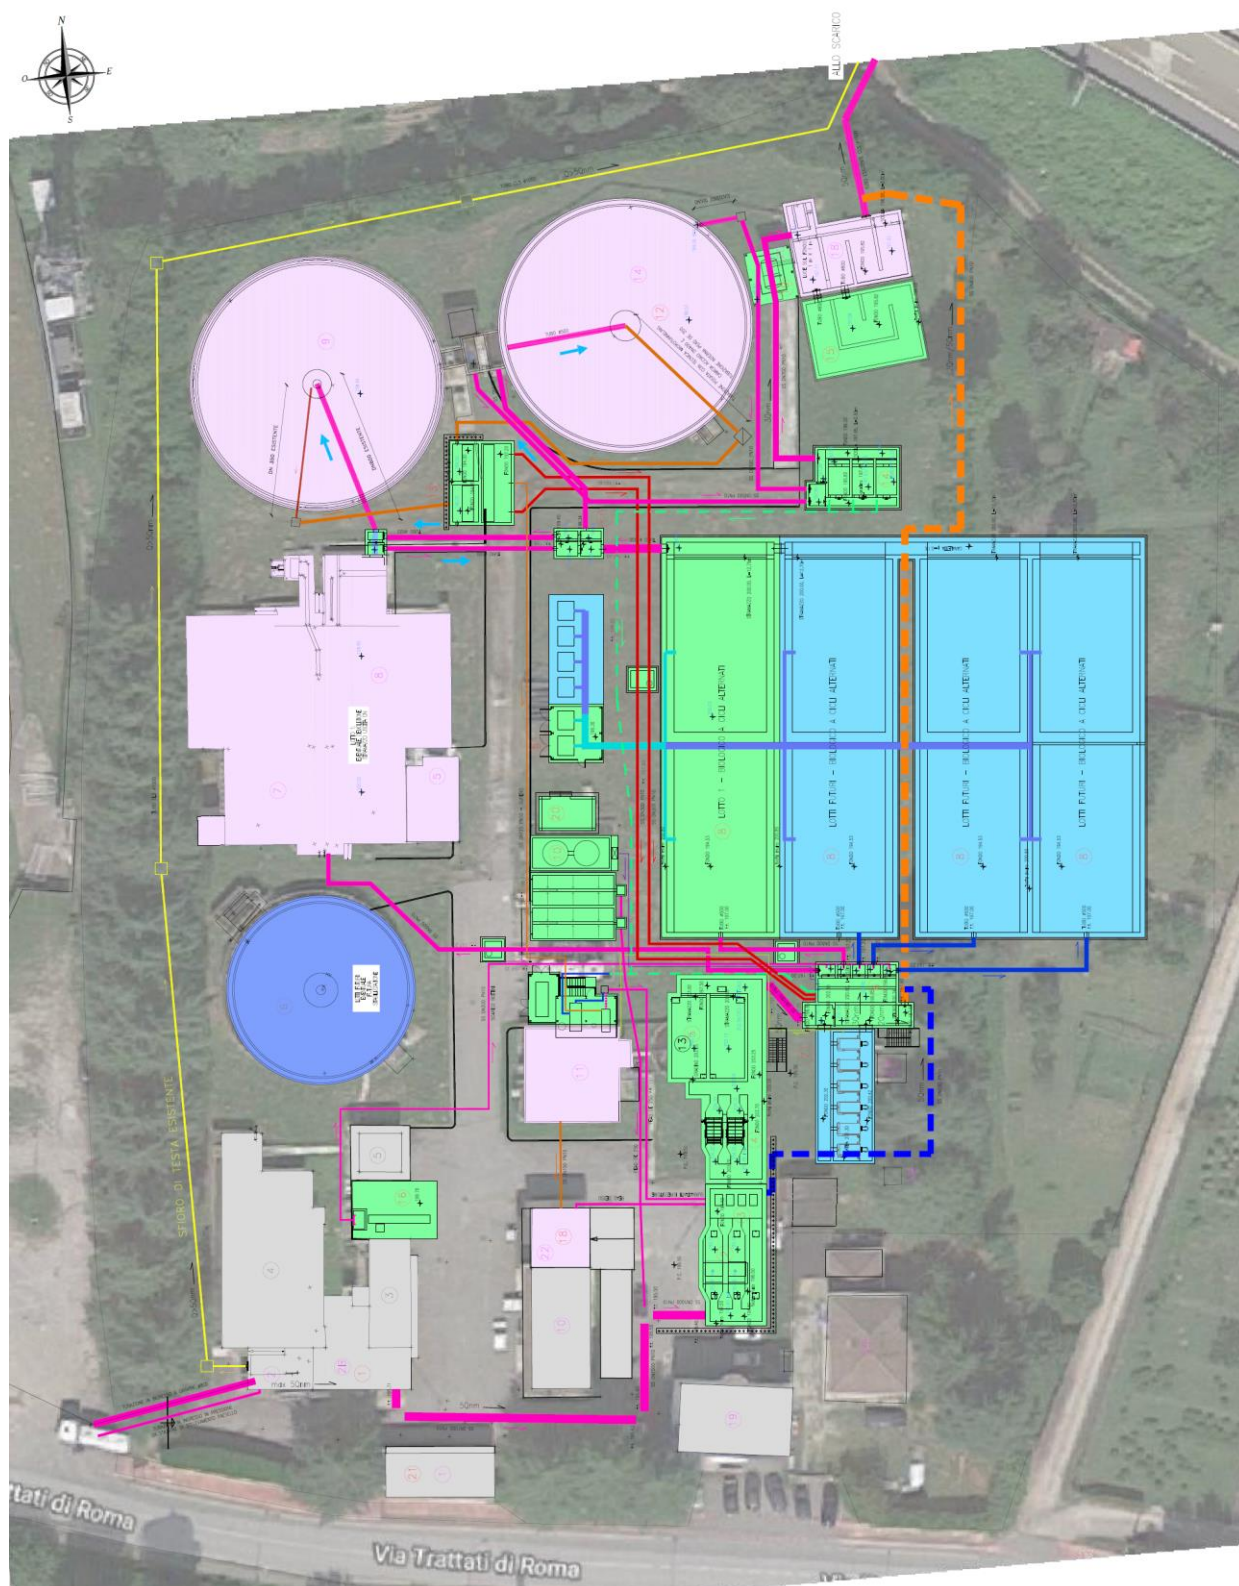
Ortofoto con rappresentazione planimetrica dell'impianto esistente e delle opere in progetto.
